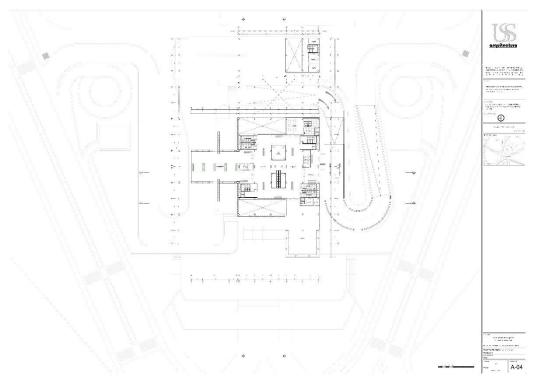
Segunda Planta- Proyecto Estación intermodal. Elaboración propia
